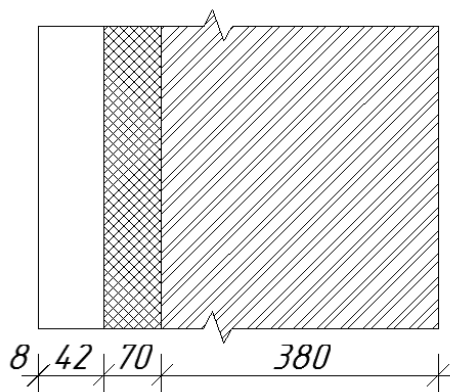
Схема конструкции ограждающей конструкции стены
